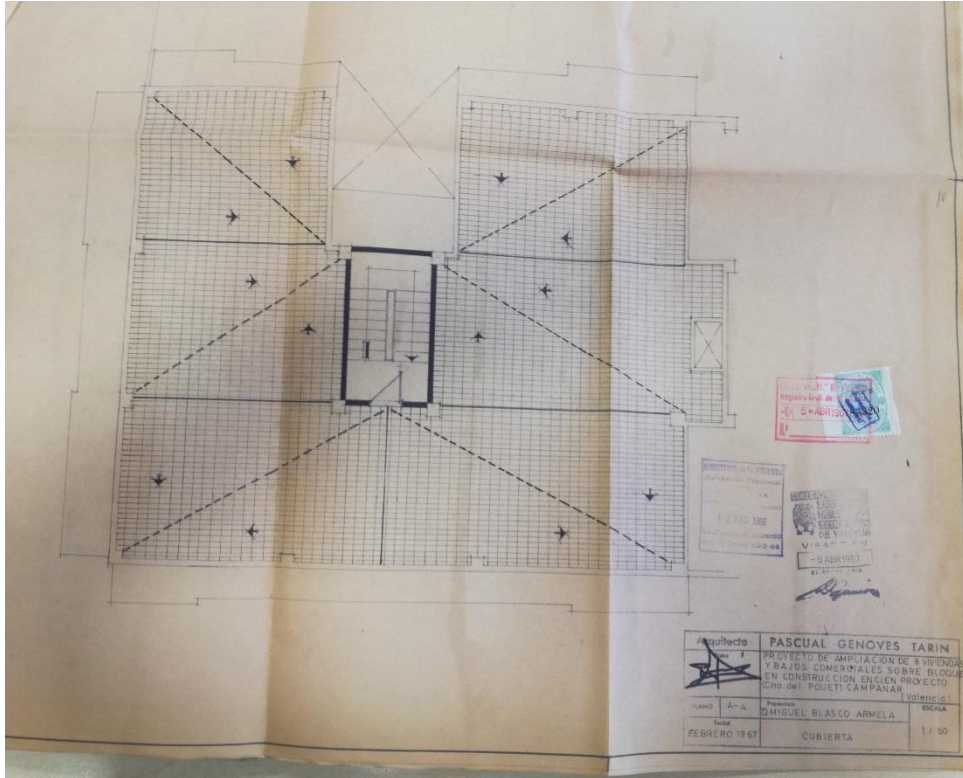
Planta cubierta Riola 1. Archivo Histórico Municipal
